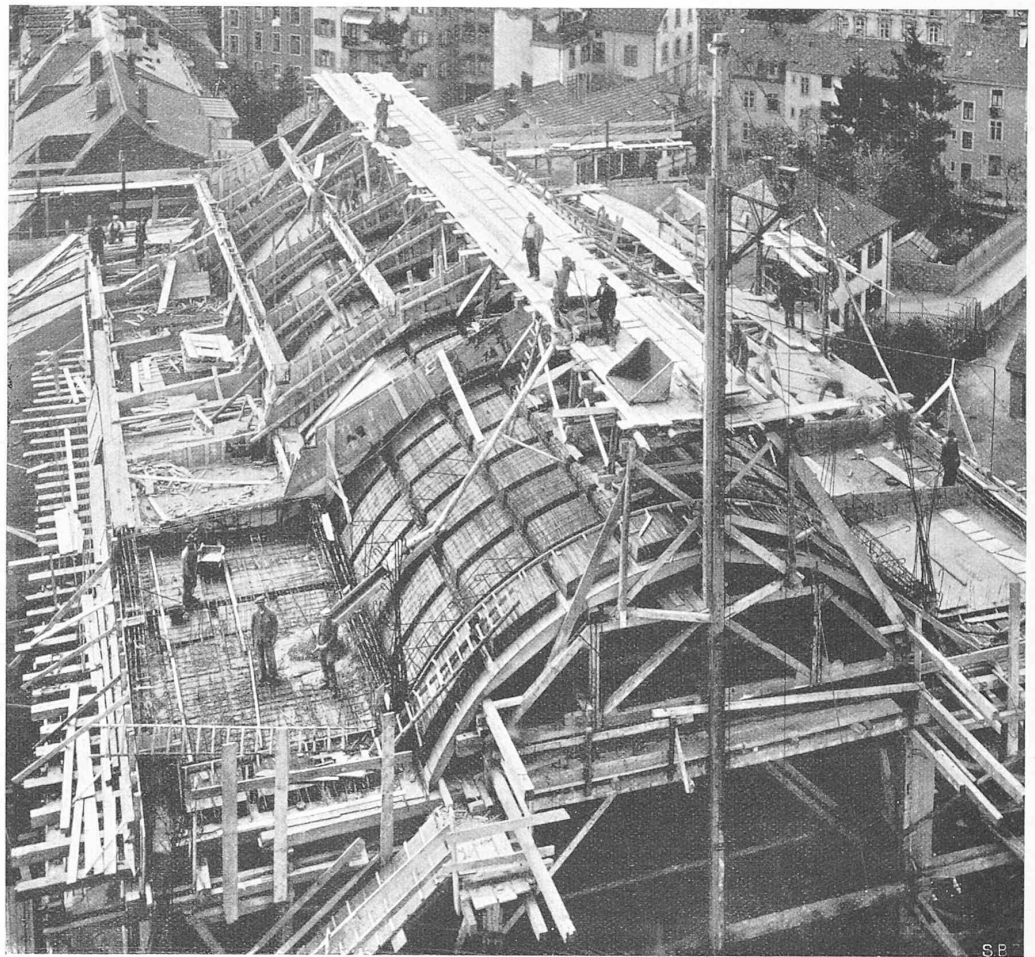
Blick vom Turm auf die Einschalung und Betonierung des Kirchendaches.
